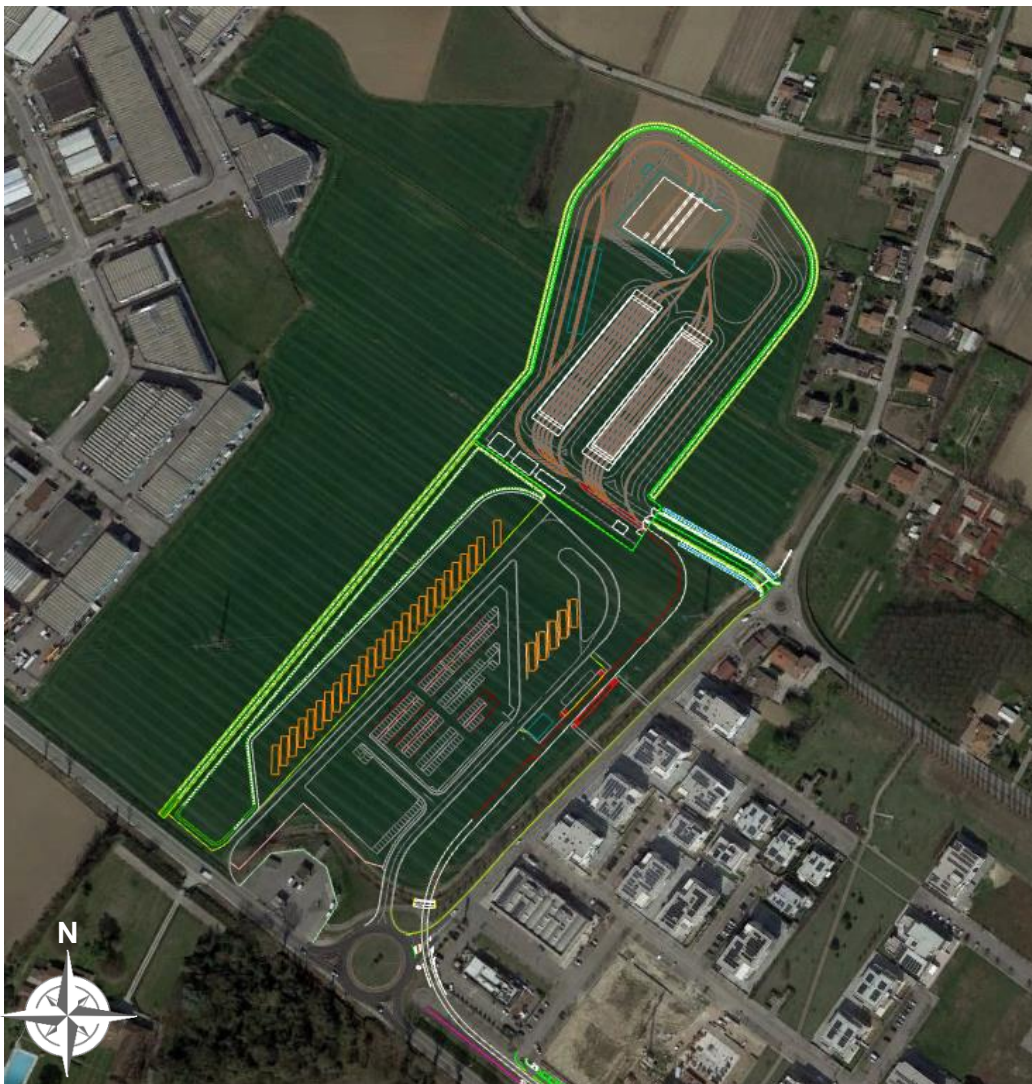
Vista aerea dell'area 1 di intervento con sovrapposizione dell'intervento di progetto (fonte Google Earth).
